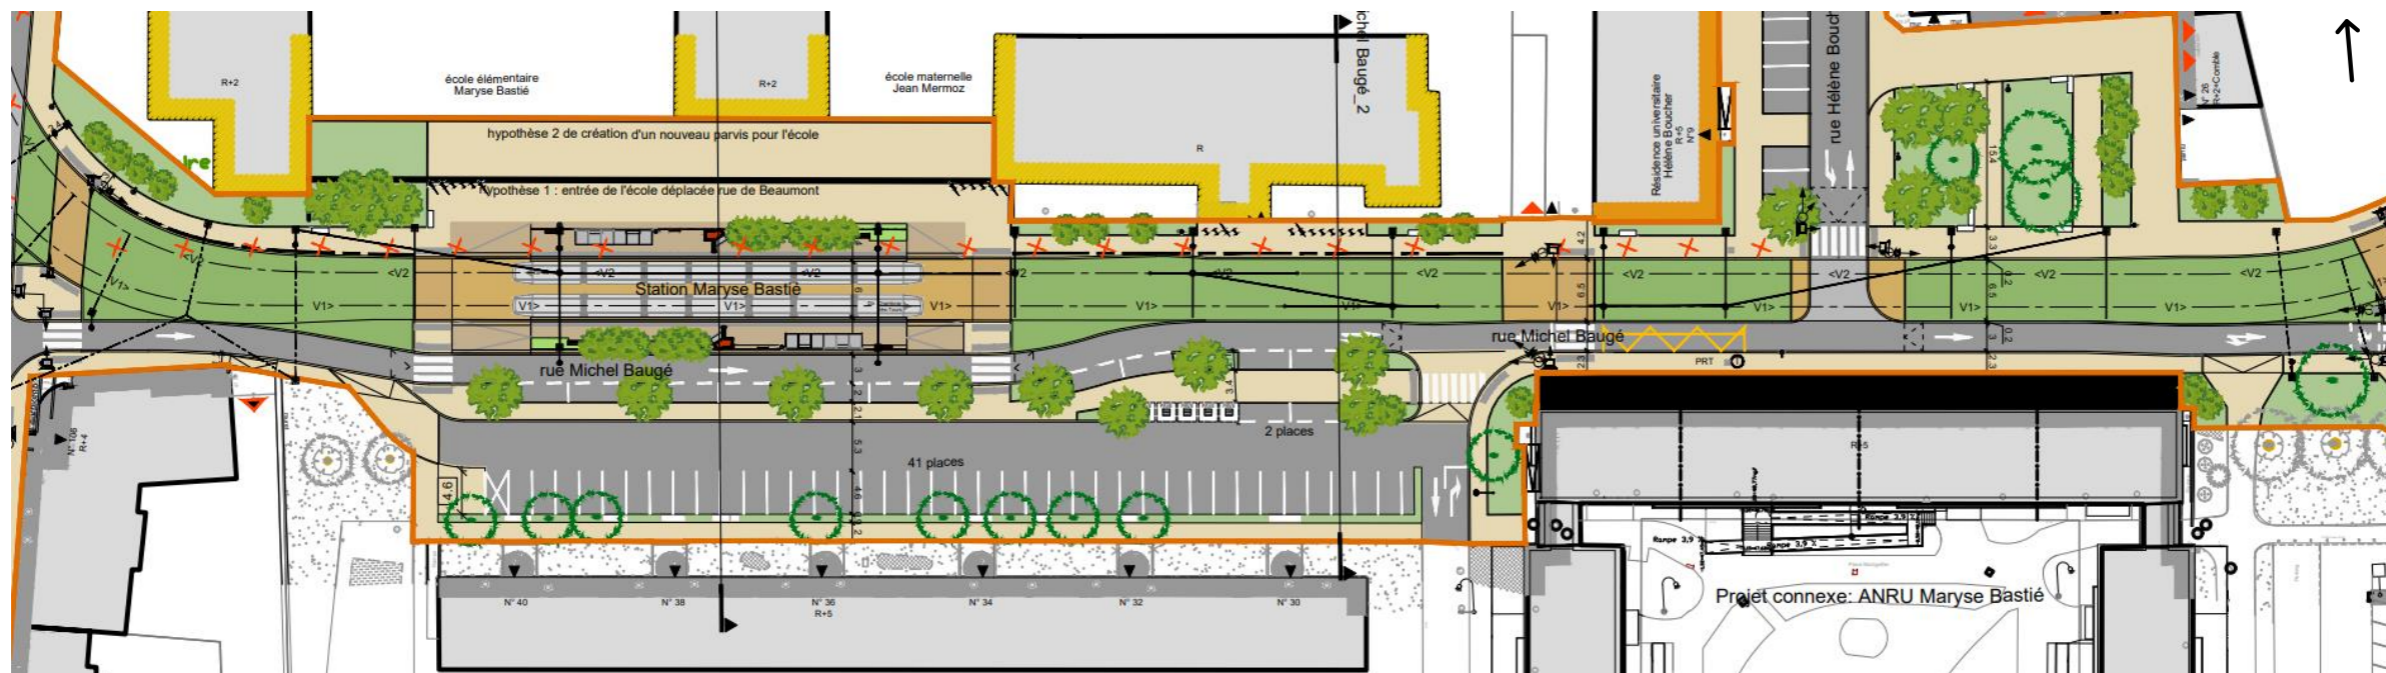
PLAN D'AMENAGEMENT RUE MICHEL BAUGE
